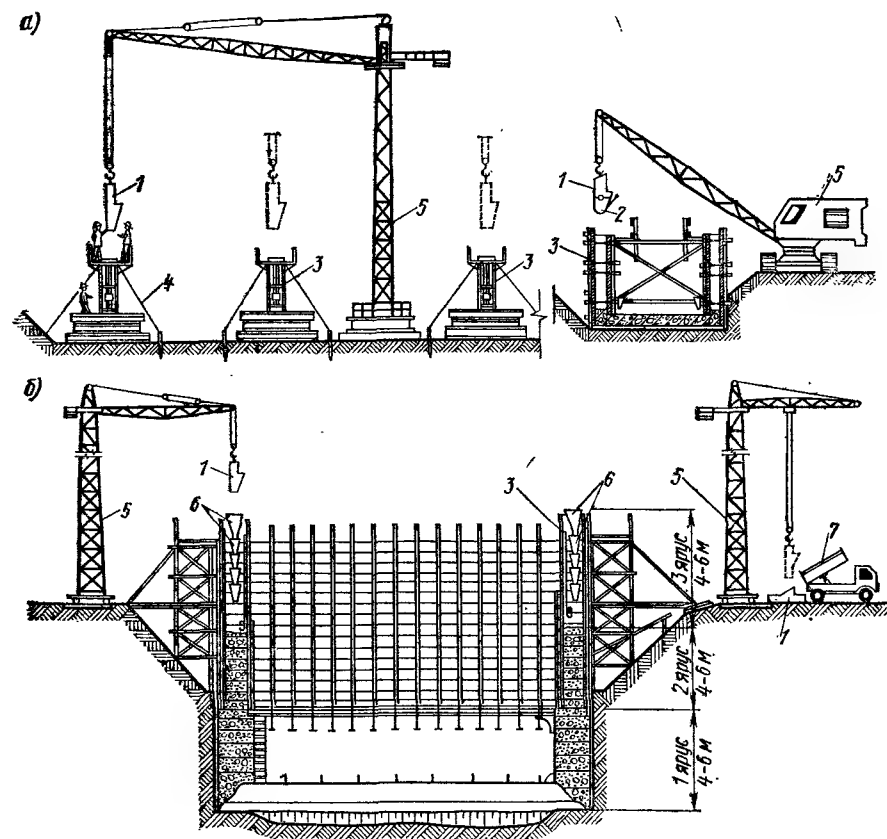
Подача бетонной смеси с помощью кранов:
